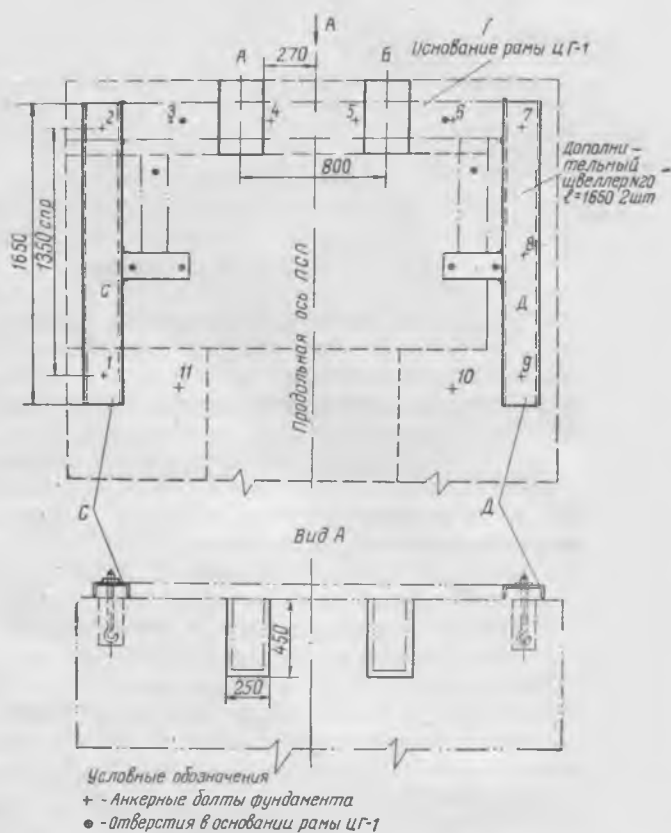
План установки зачищающего узла ЦГ-1 на фундамент ПСЛ-1:
